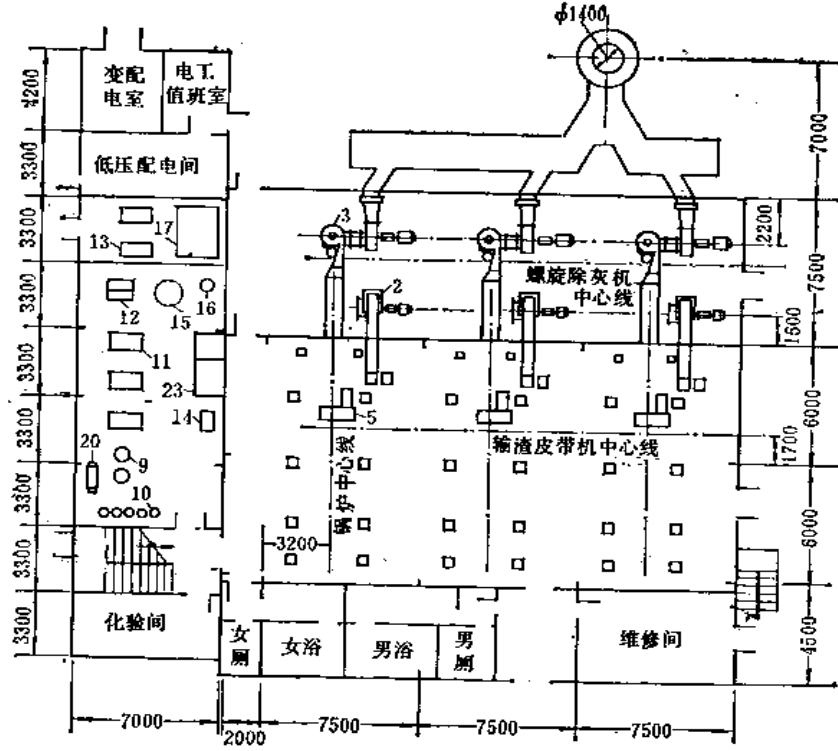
三台QXL600-13/100型锅炉房底层平面图
